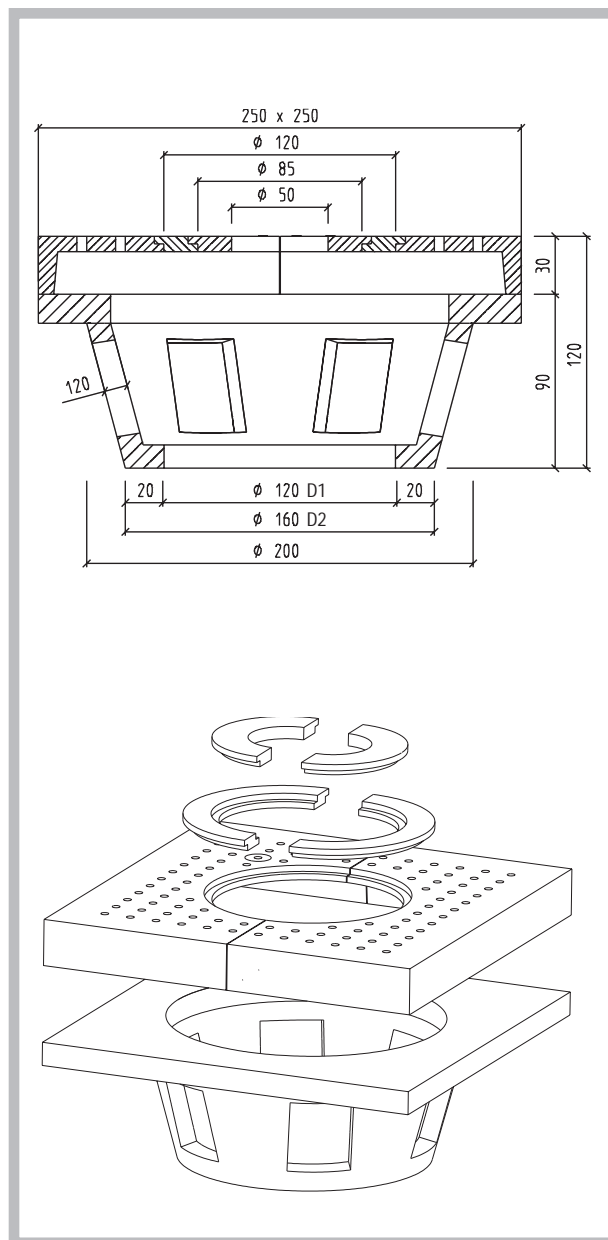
Baumquartiere aus Beton bieten den Bäumen in befestigten Flächen einen vor Verdichtung geschützten Wurzelraum. Der kleine Wurzelraum muss durch Wurzelgräben oder den flächigen Einbau von verdichtungsfähigem Substrat vergrößert werden.
